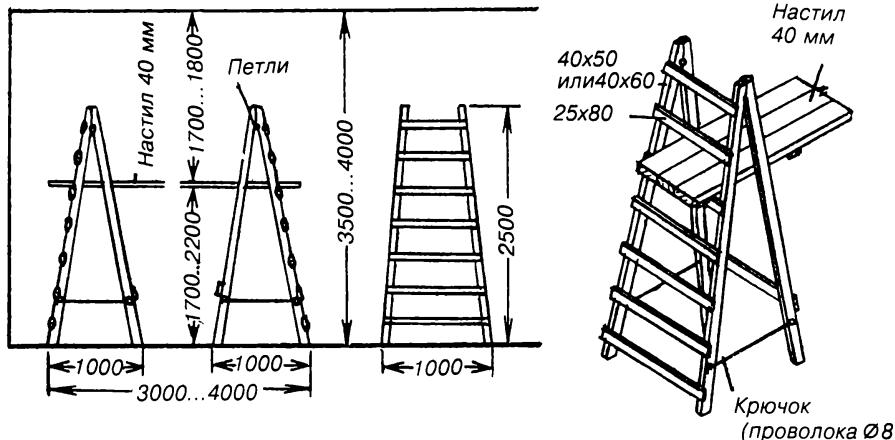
Лестница-стремянка для отделки помещений высотой до 4 м.
